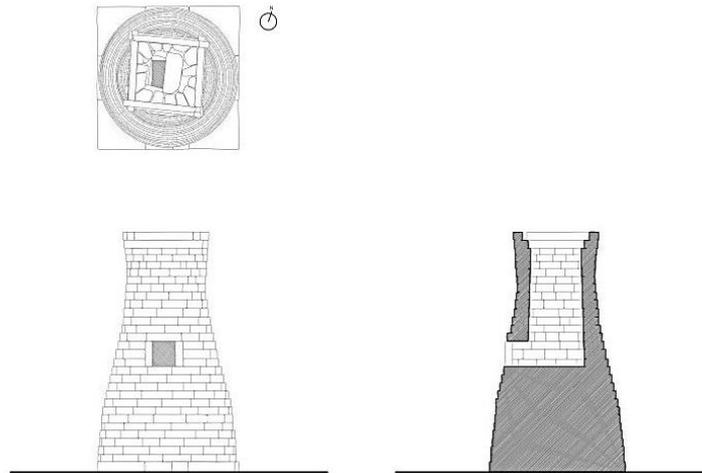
Cheomseongdae. Planta, alzado y sección.
